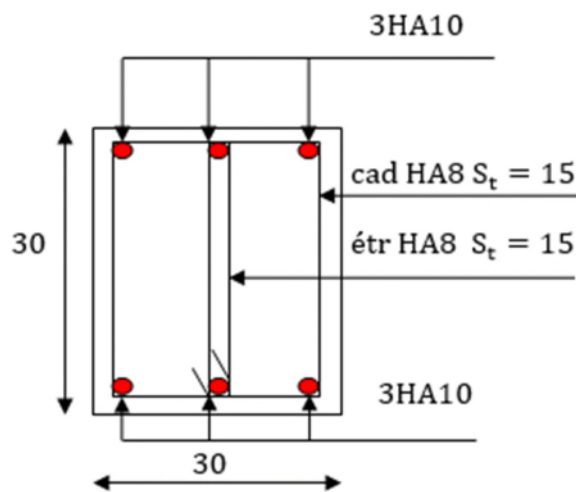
Schéma de ferrailage de la poutre de chaînage
